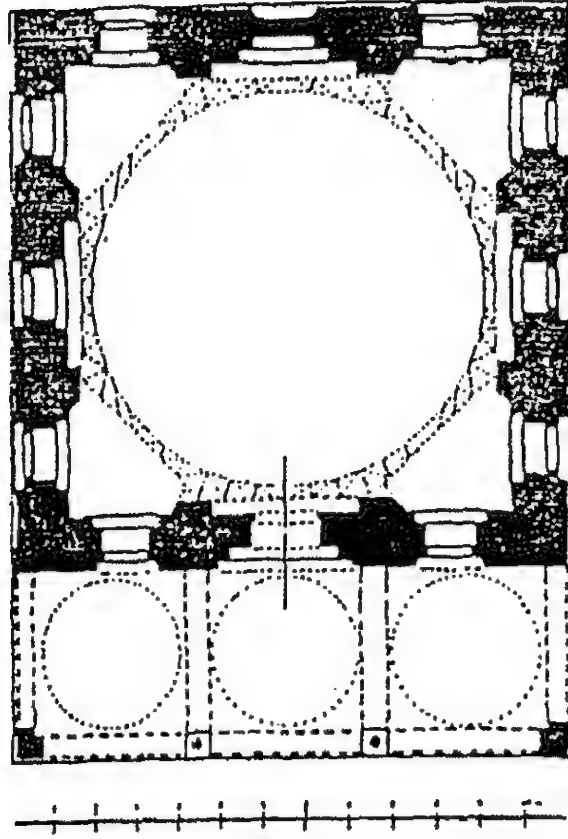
مسقط أفقي لمسجد الياس بك في كورتزه (عن : كيل) .
